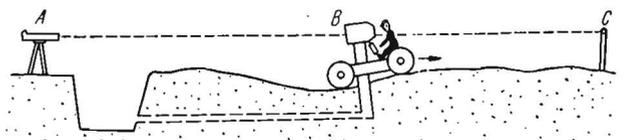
Steuerung in die gewünschte Sollage mit Hilfe des Lichtstrahlverfahrens. A Scheinwerfer, B Lichtschutzkasten, C Peilstab
